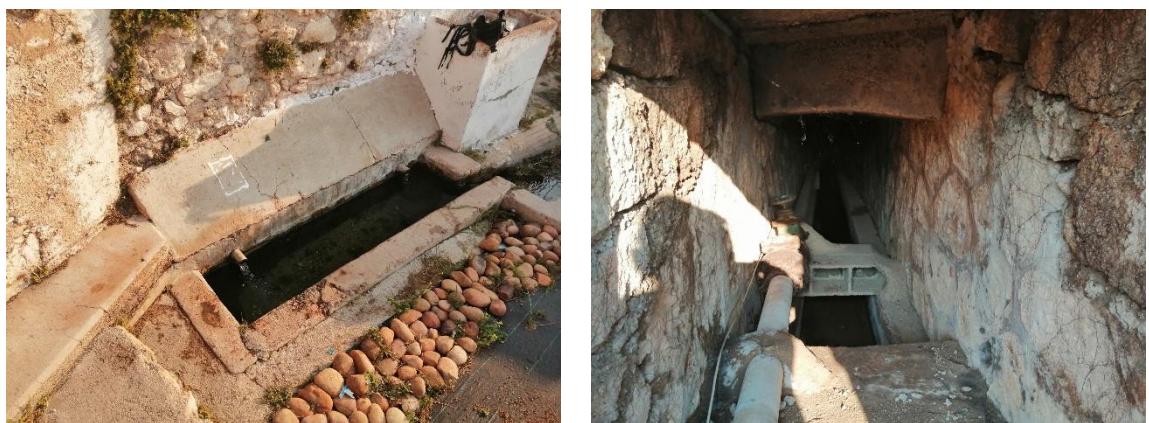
Fuente de Moriscote. Detalle de la fuente y la galería de captación.
